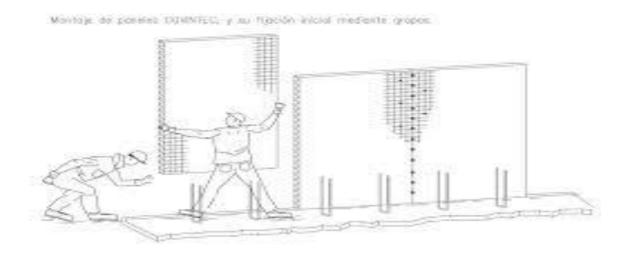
detalles de mampostería Aislapanel Fuente: Aislapol s.a
